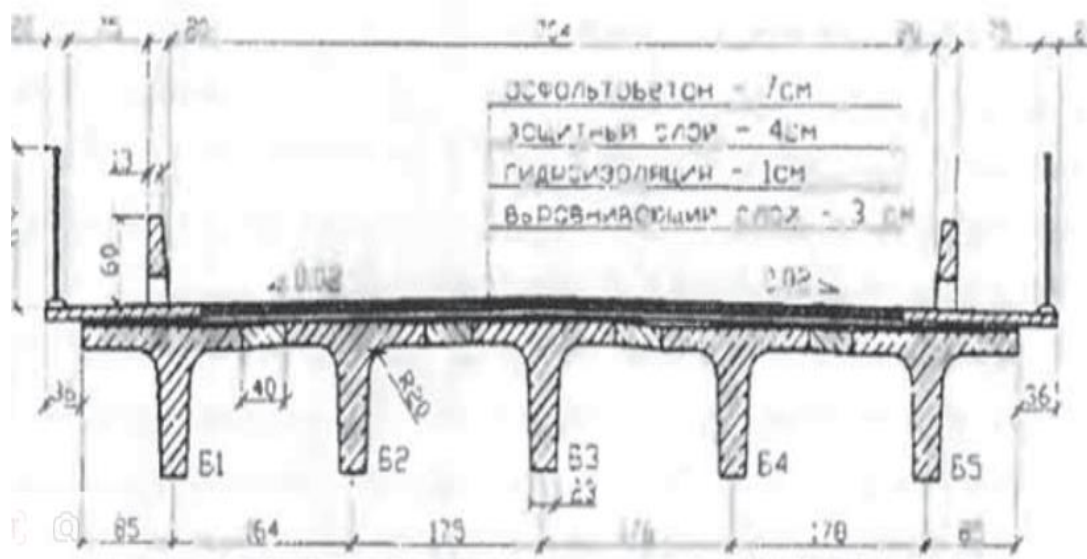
Поперечное сечение пролетного сооружения с применением напрягаемой стеклопластиковой арматуры в железобетонных балках
